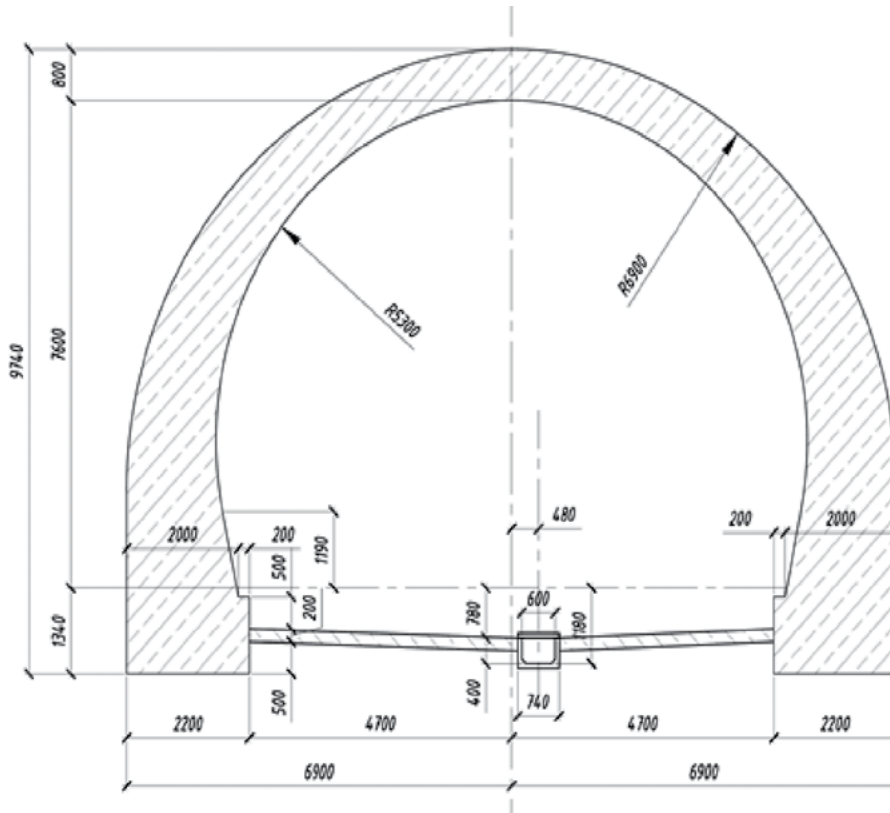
Чертеж типовой конструкции обделки тоннеля Сухарный
